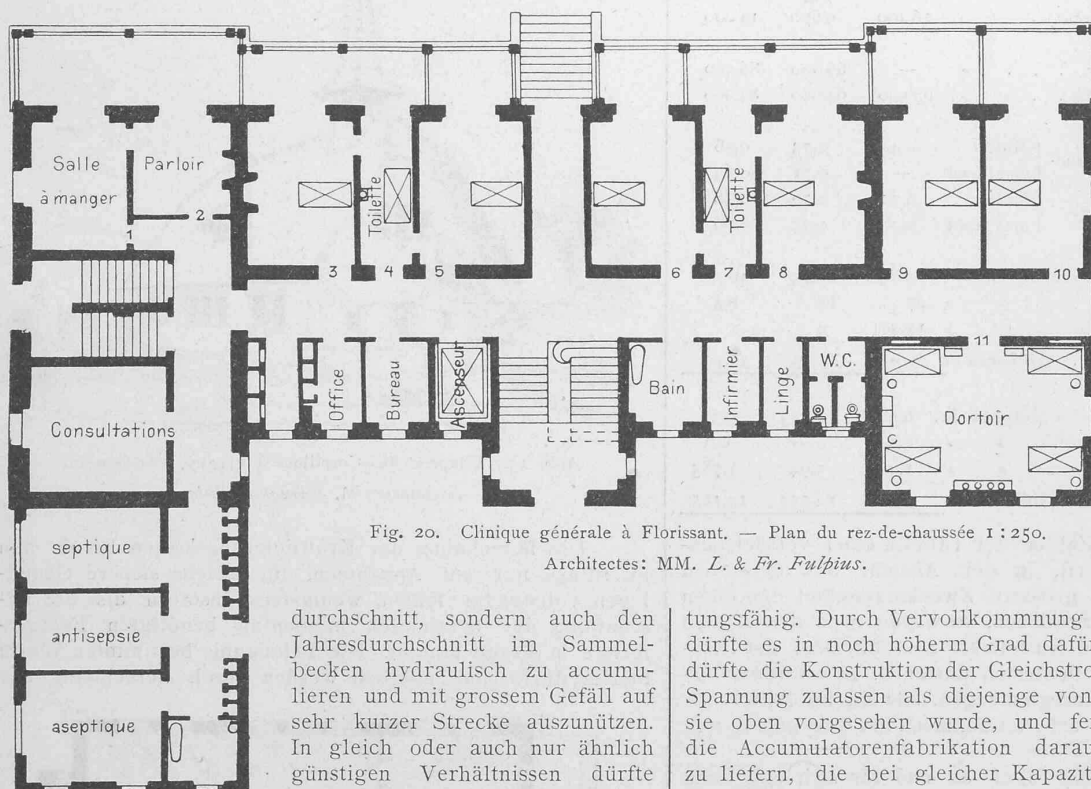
Clinique générale à Florissant. — Plan du rez-de-chaussée 1:250.
